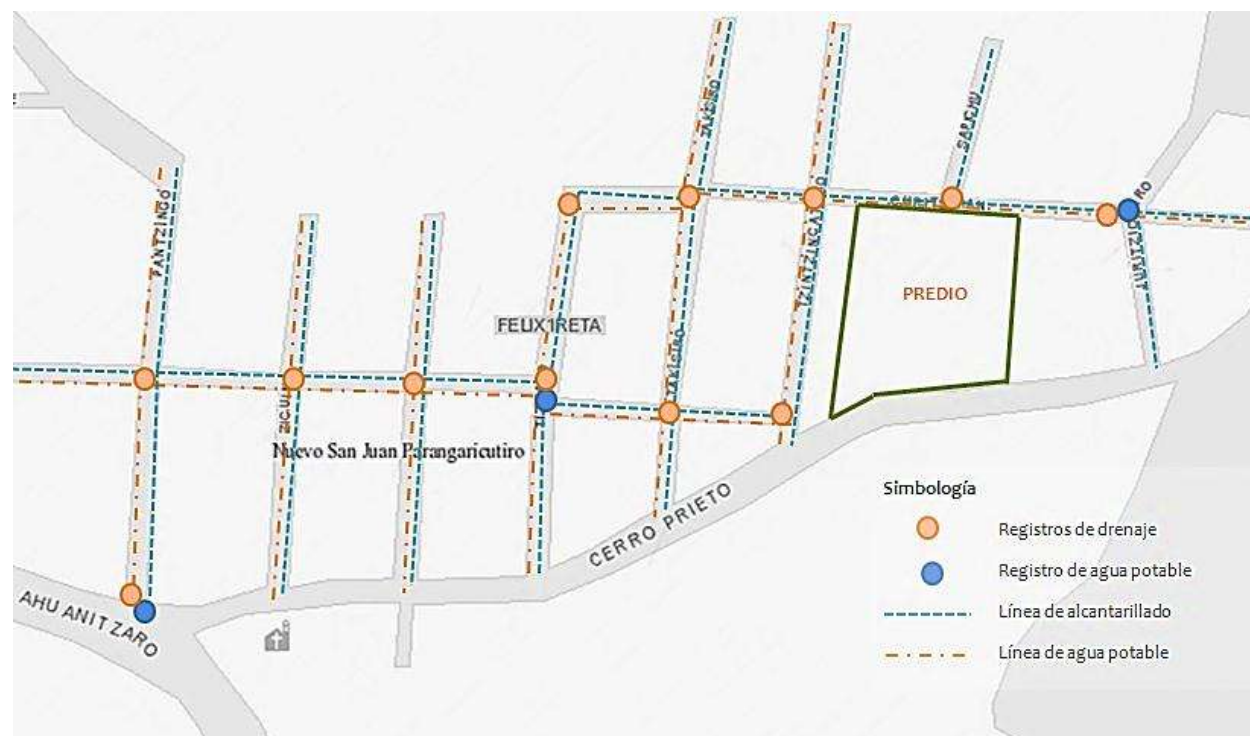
Levantamiento de red de alcantarillado y agua potable, en el Fraccionamiento Félix Ireta. Por: Stephanie Silva Delgado. 2010
